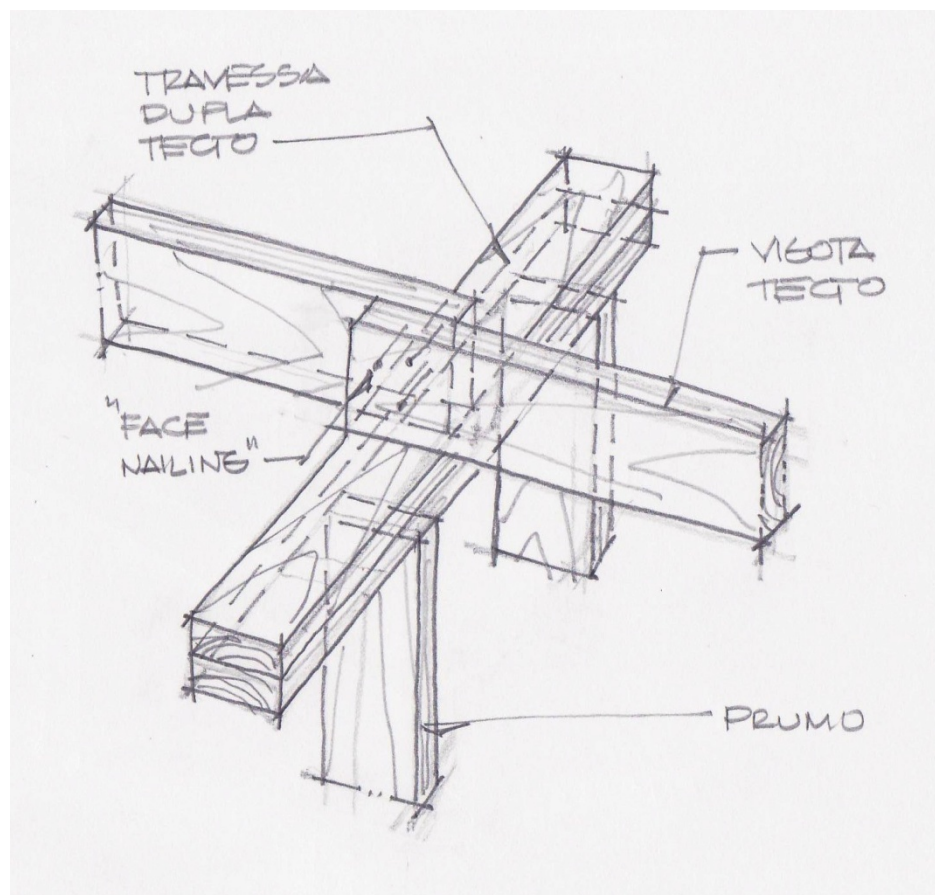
Pregagem entre vigotas sobre apoio intermédio. (des. autor)
